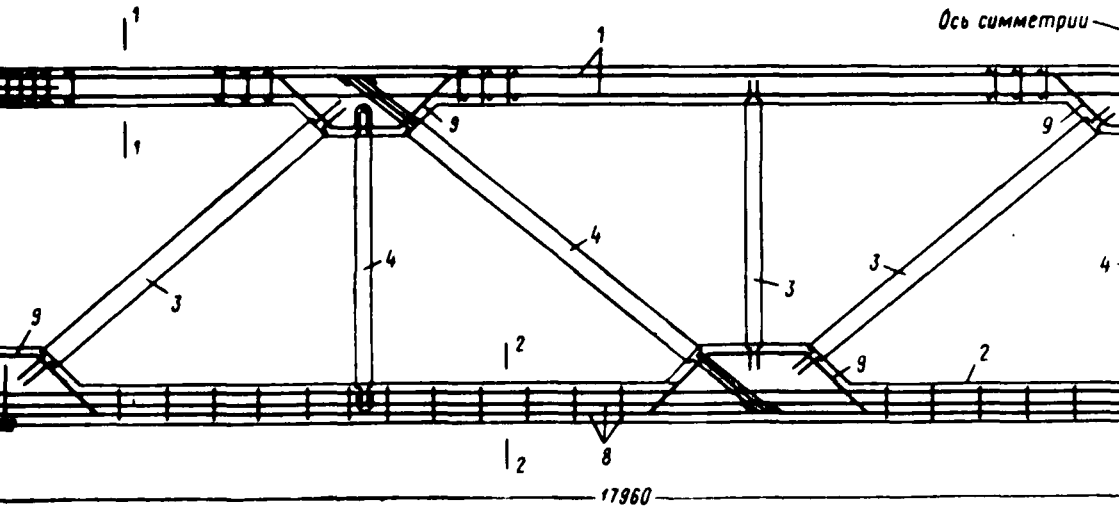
Типовая ферма пролетом 18 м для зданий с плоской кровлей по серии ПП-01-С. 1 — каркас верхнего пояса; 2 — предварительно напряженный нижний пояс с арматурой в нескольких вариантах; 3 — стойки; 4 — закладные растянутые раскосы и стойки; 5 — вариант прядевой арматуры; 6 — вариант проволочной сетки; 7 — вариант стержневой арматуры классов А-III и А-IV; 8 — окаймляющие П-образные каркасы; 9 — пространственные
